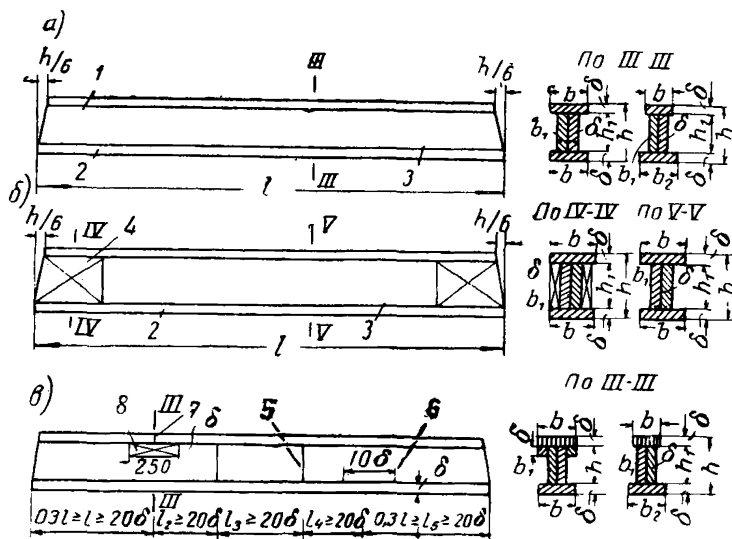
Типы деревянных клееных балок со стенкой из досок на ребро
